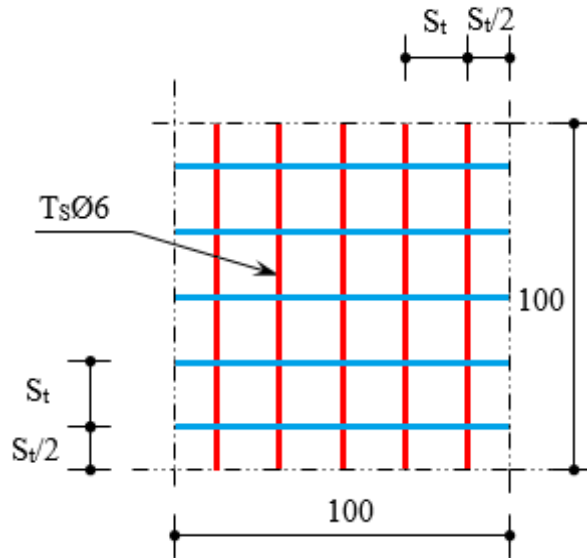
Disposition constructive des armatures de la dalle de compression
